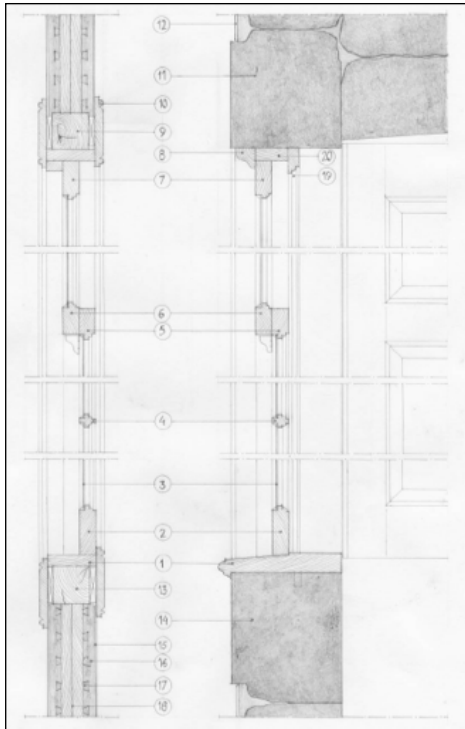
Pormenor tipo do sistema construtivo Caixilharias
